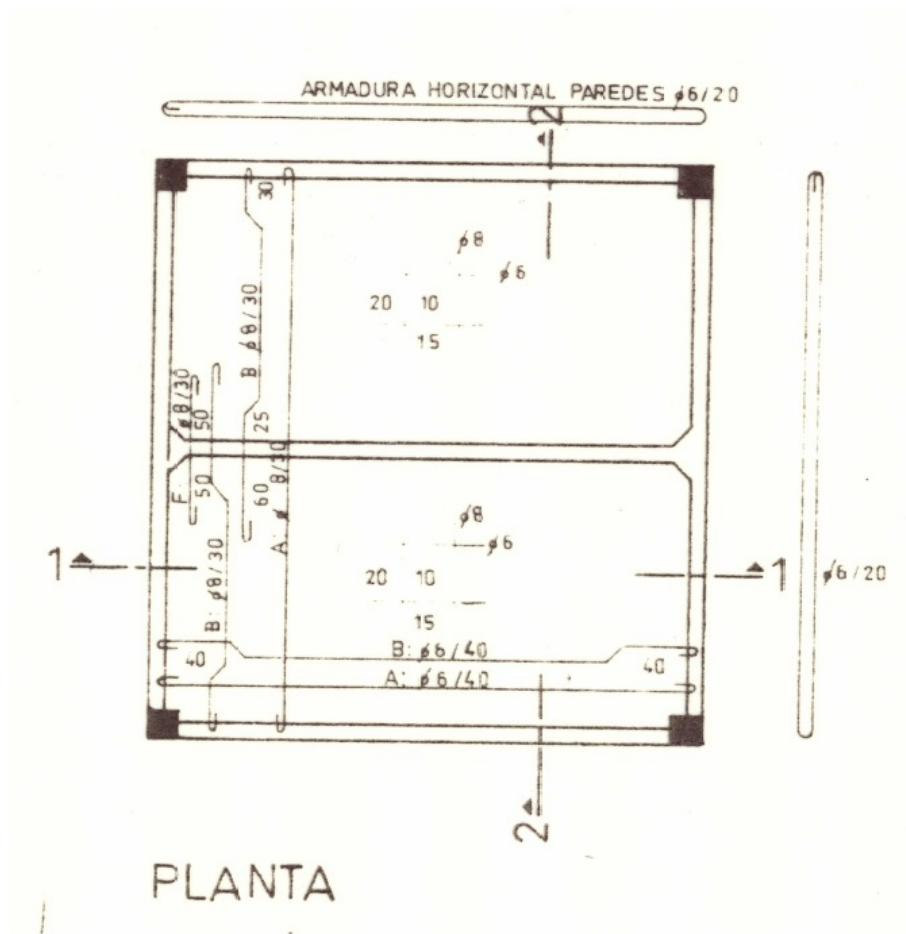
Planta del tanque de agua, donde se observa la geometría y armadura.
